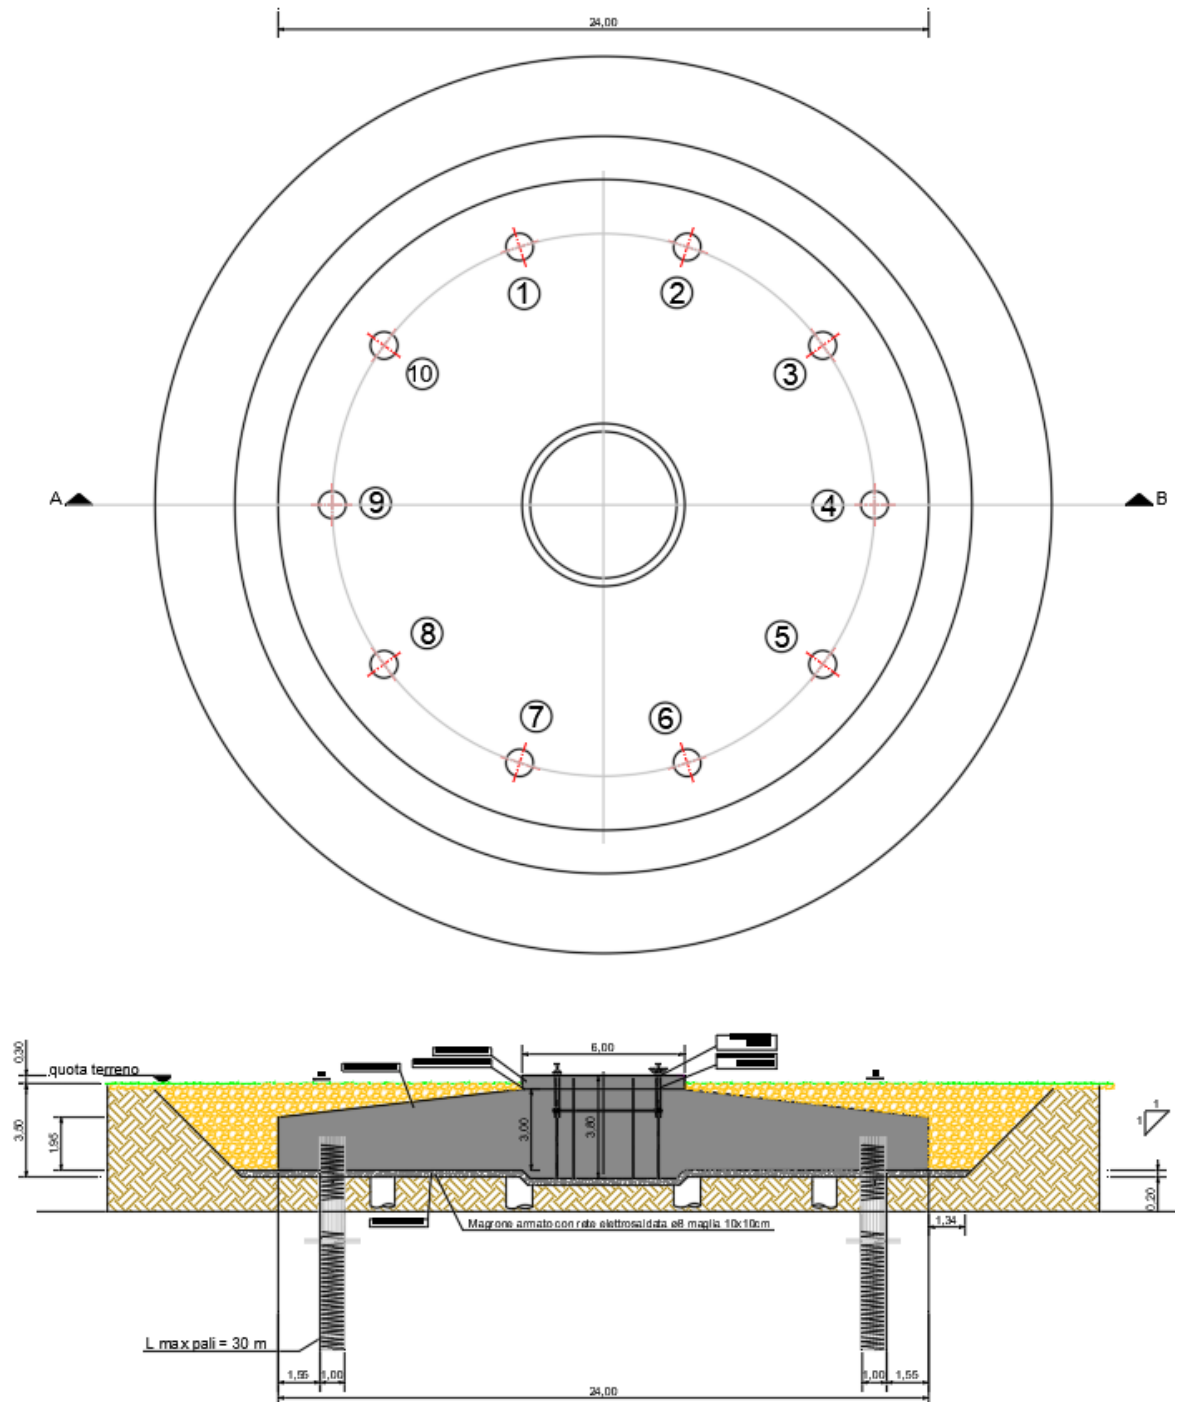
FONDAZIONE INDIRECTA - PLATEA E PALI IN SEZIONE E CARPENTERIA
